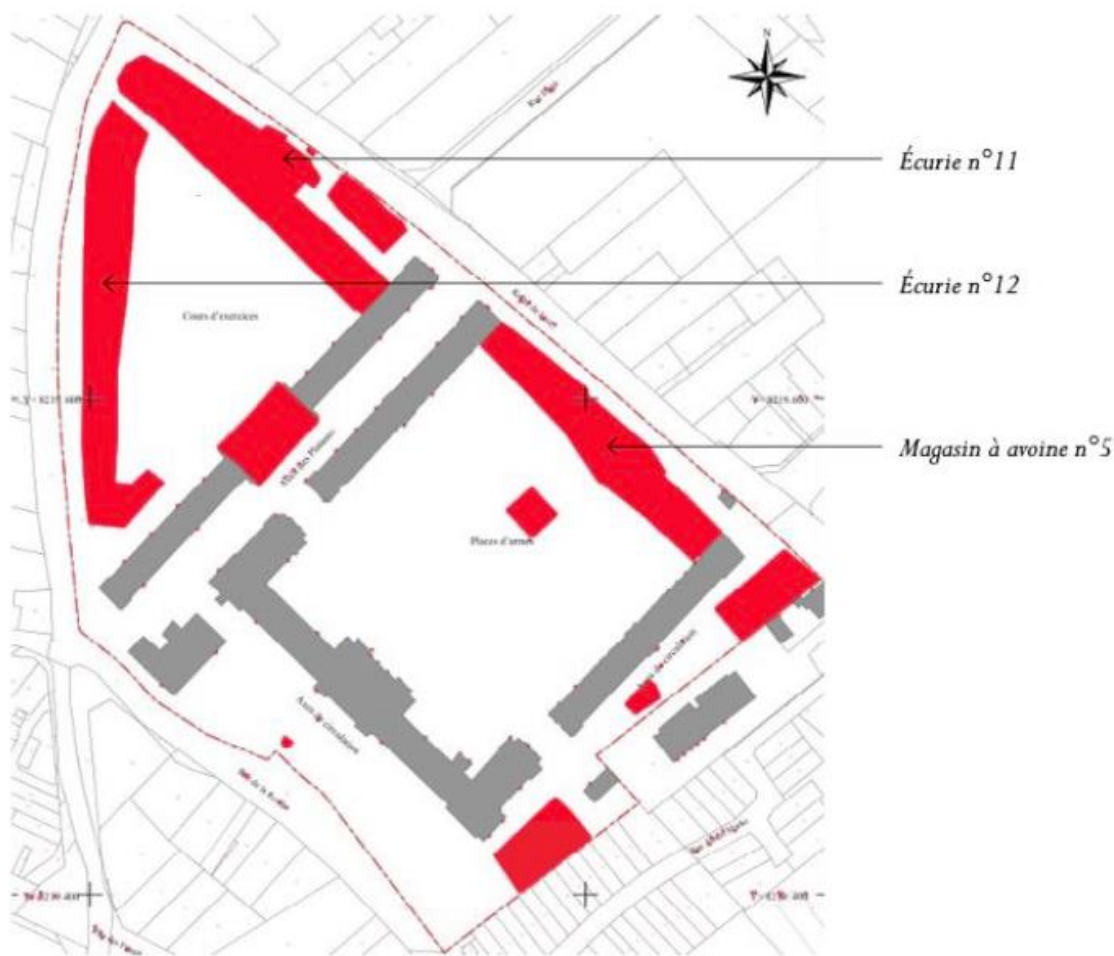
Plan des édifices déconstruits-démolis (EPFL)
